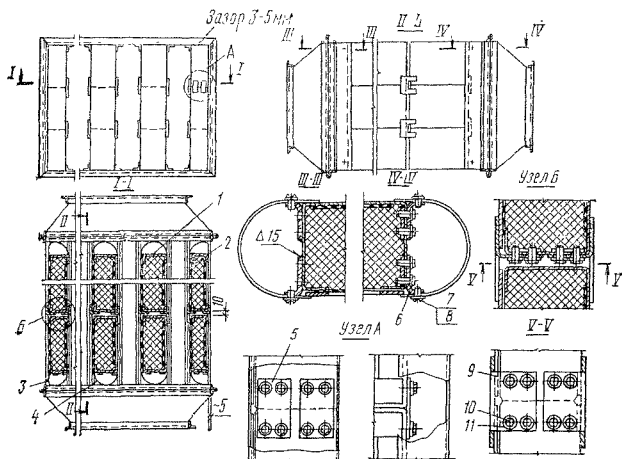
Схема сборки пластинчатого шумоглушителя
